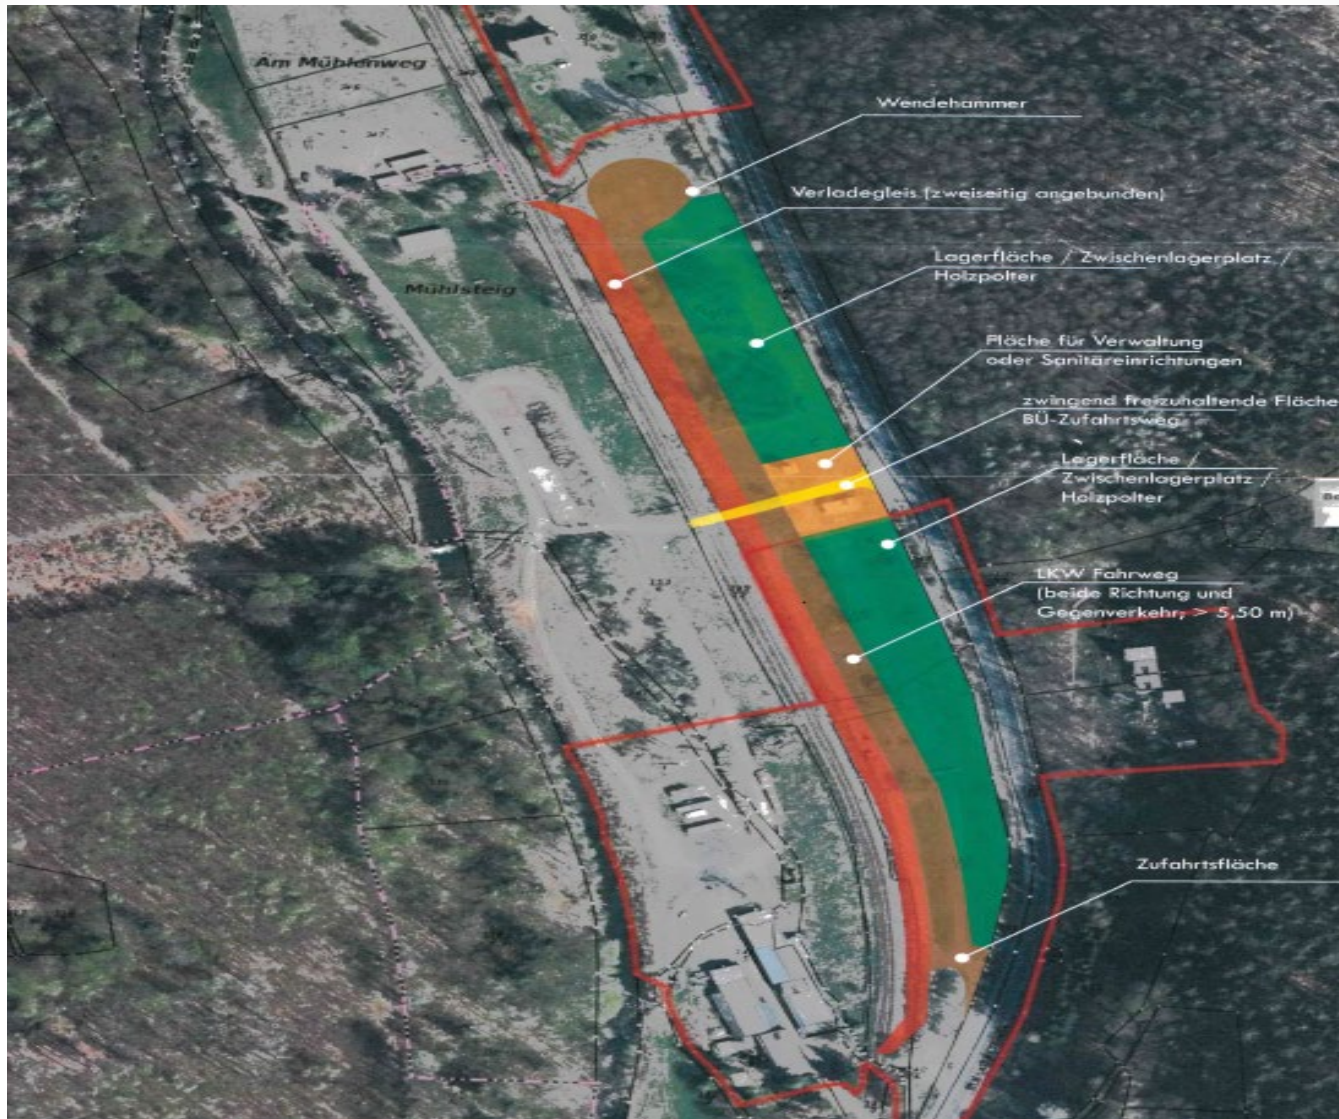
Lageplan alternative Ladestelle Sonneberg
